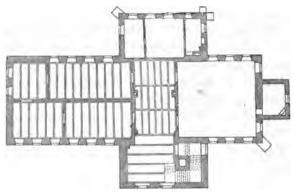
Ludwigsburg. Schloss. Grundriss des ersten Obergeschosses. 1:500
